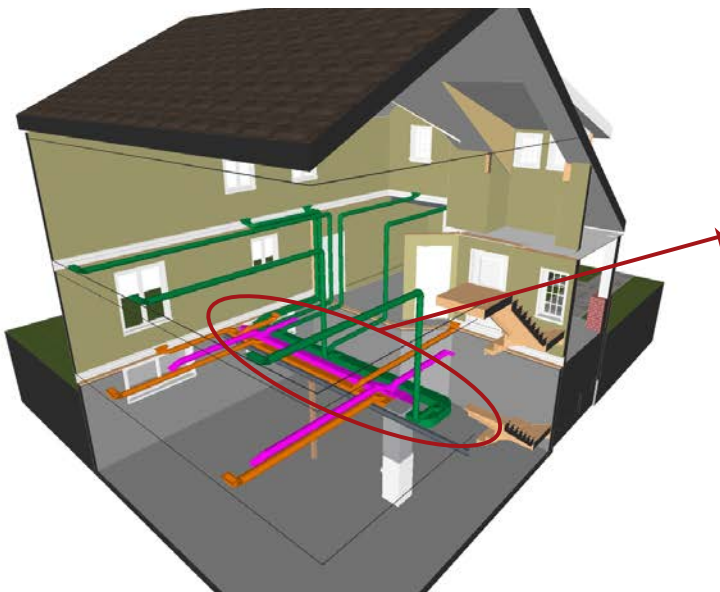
Conduits d'alimentation des zones du sous-sol, du rez-de-chaussée et de l'étage
